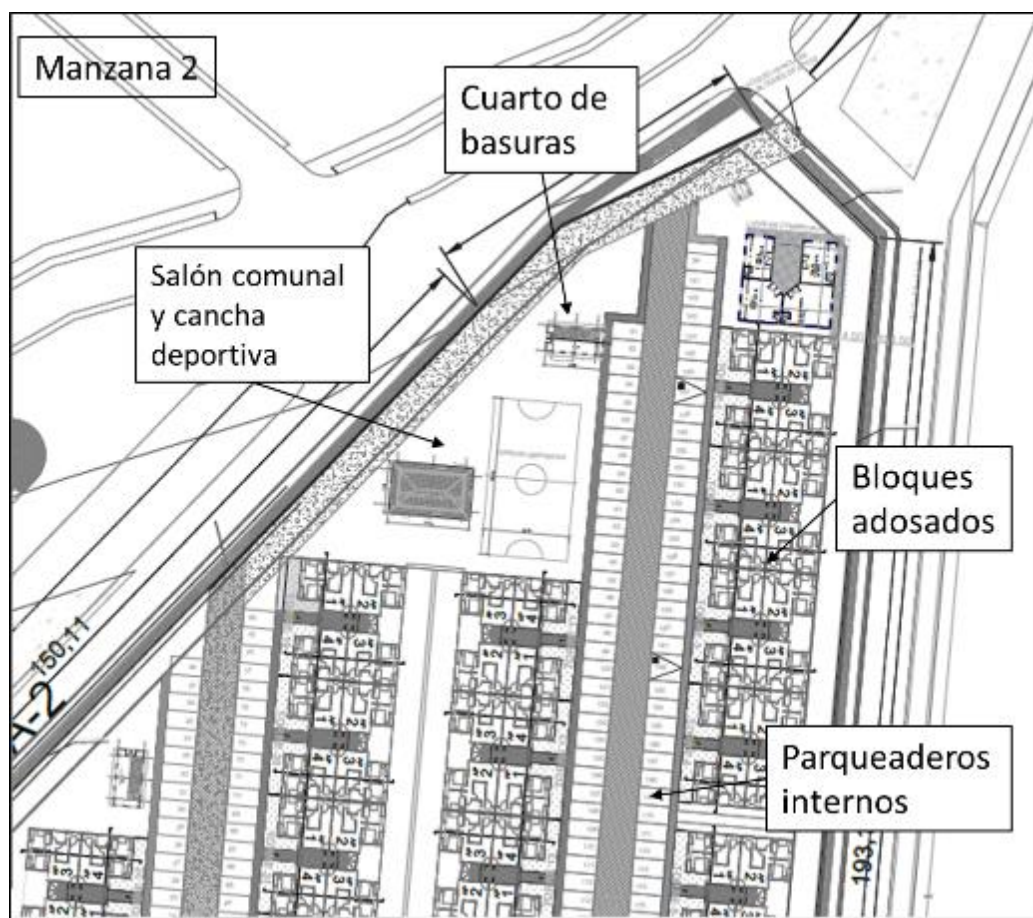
Plano urbanístico manzanas VIPA Verde, PPCC.
